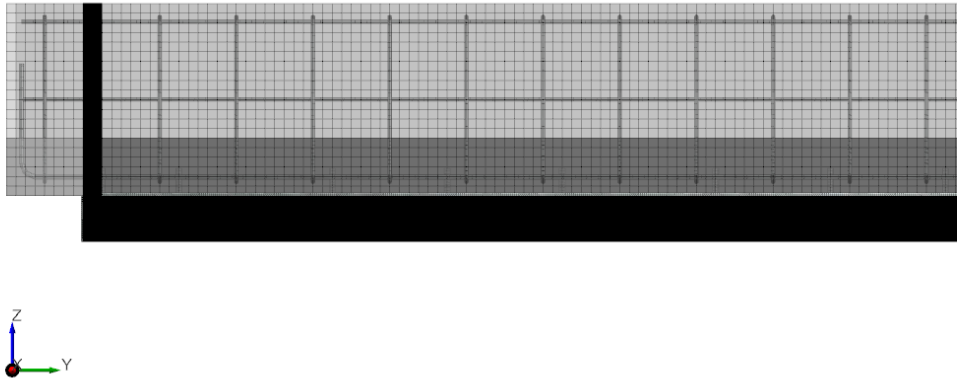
Vista lateral de la viga modelizada con pletinas ancladas.
